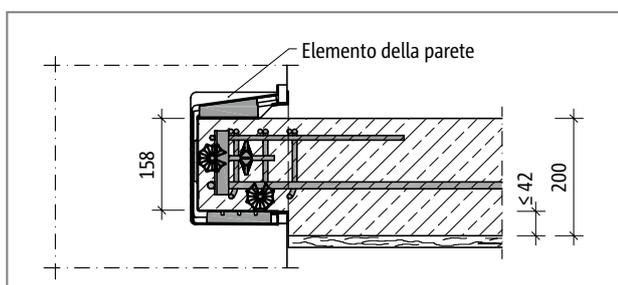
Schöck Tronsole® tipo Z, elemento previsto con cassero a perdere; l'intradosso del solaio più basso dell'elemento.
